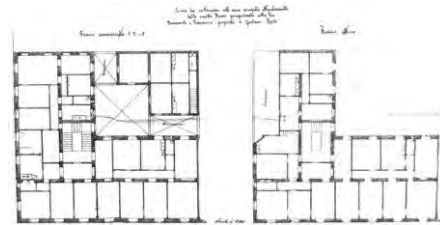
casa in via Buonarroti piante dei piani superiori e attico
